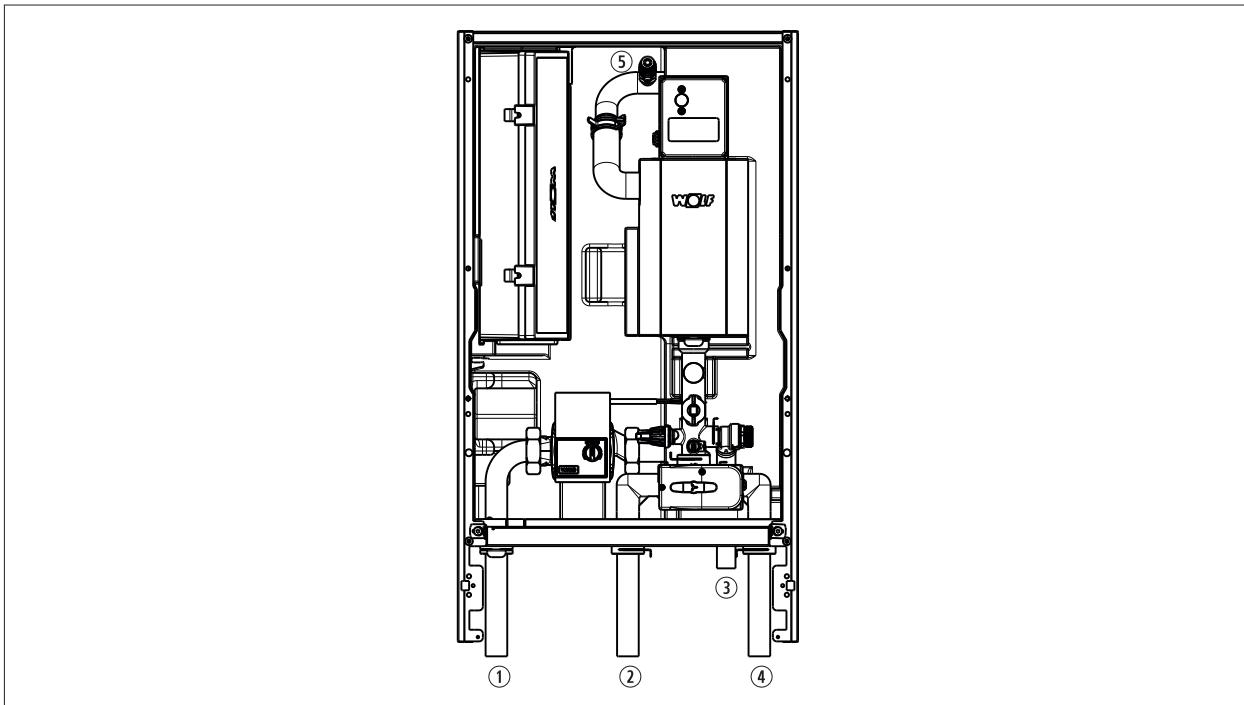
Prestavba hydraulického pripojenia vonkajšej jednotky
